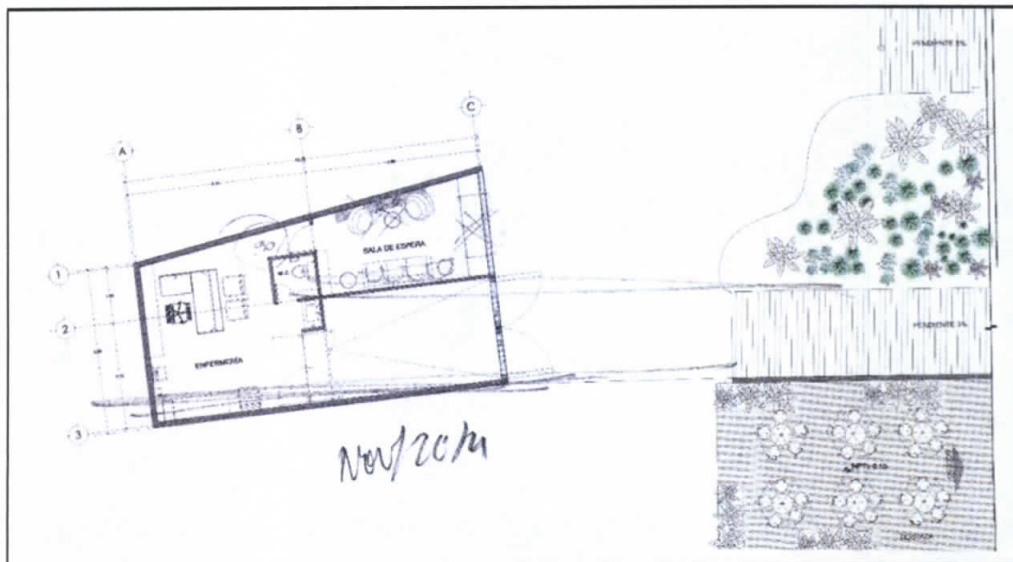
Planta –Enfermería. (FUENTE: Coordinación de Vinculación y Proyectos Especiales, Facultad de Arquitectura 2014)
